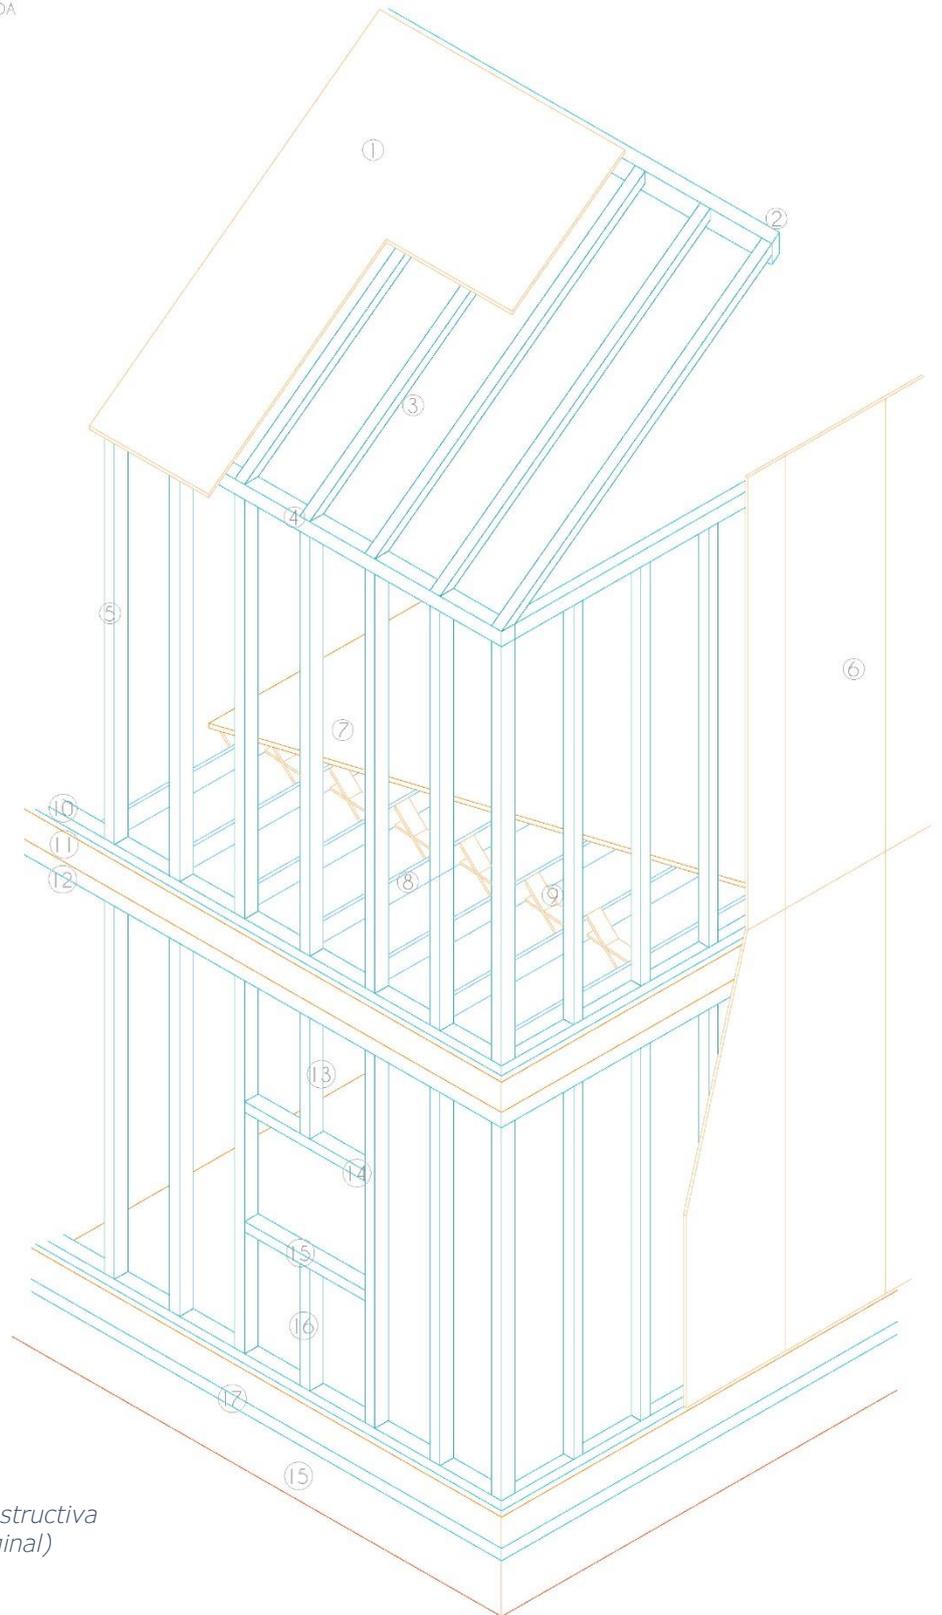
Axonometría constructiva Platform Frame (Dibujo original)
